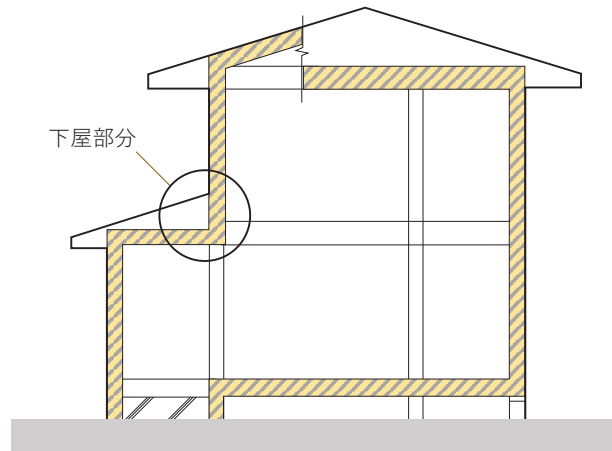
工程5 下屋部分の天井及び下がり壁の施工
